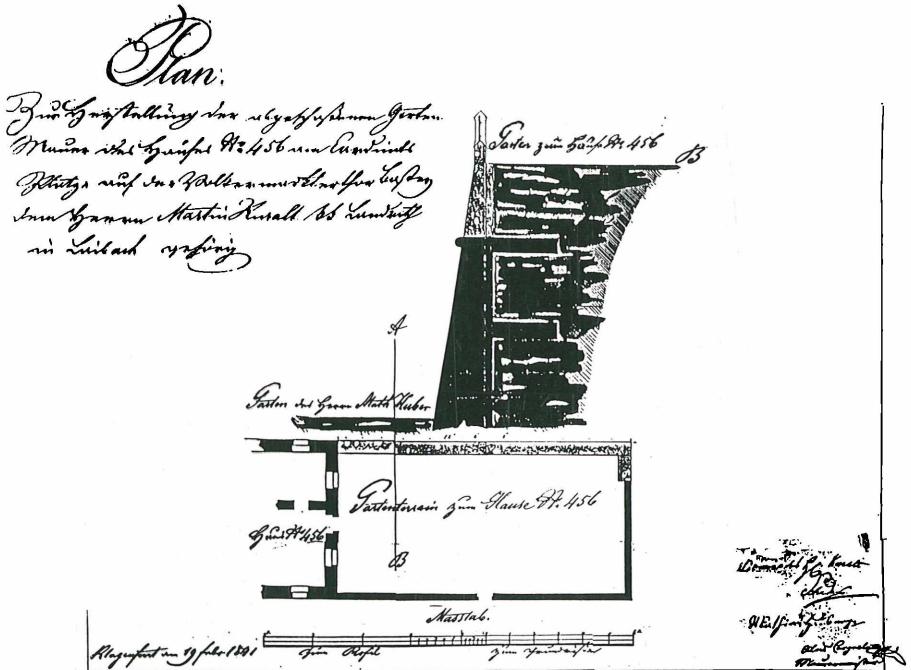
Plan zur Herstellung einer Mauer um das Schüttgärtchen.
